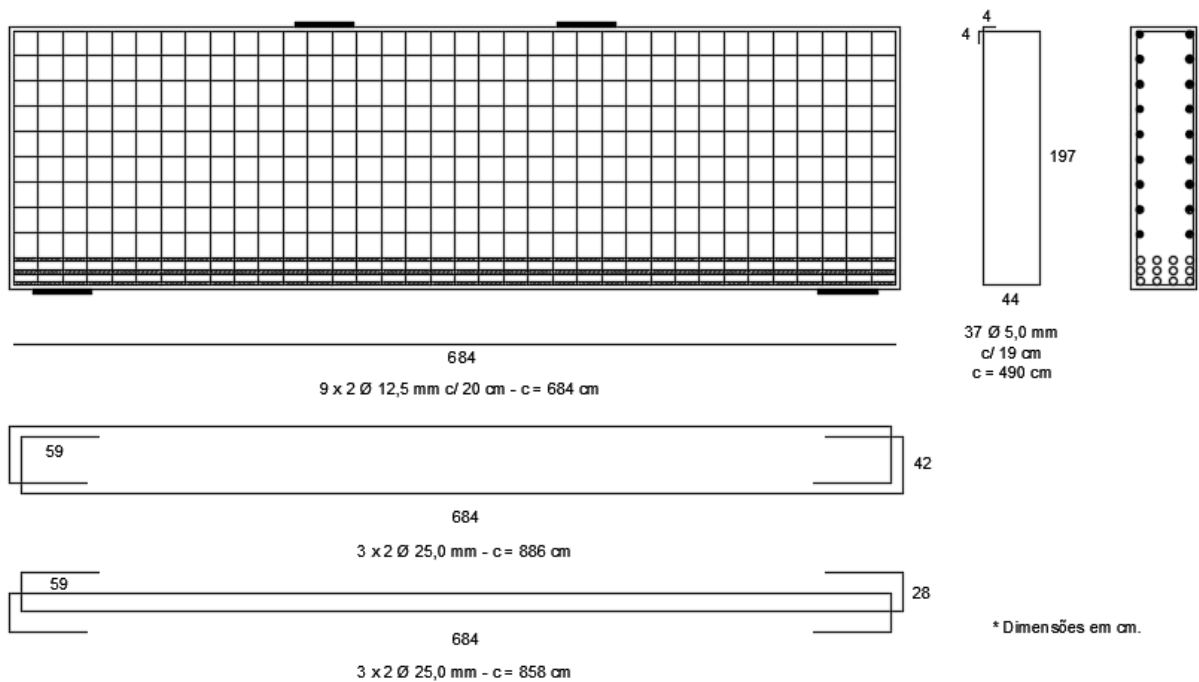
Detalhamento da armadura do modelo de viga-parede A, obtido com dimensionamento segundo Fib (2012)
